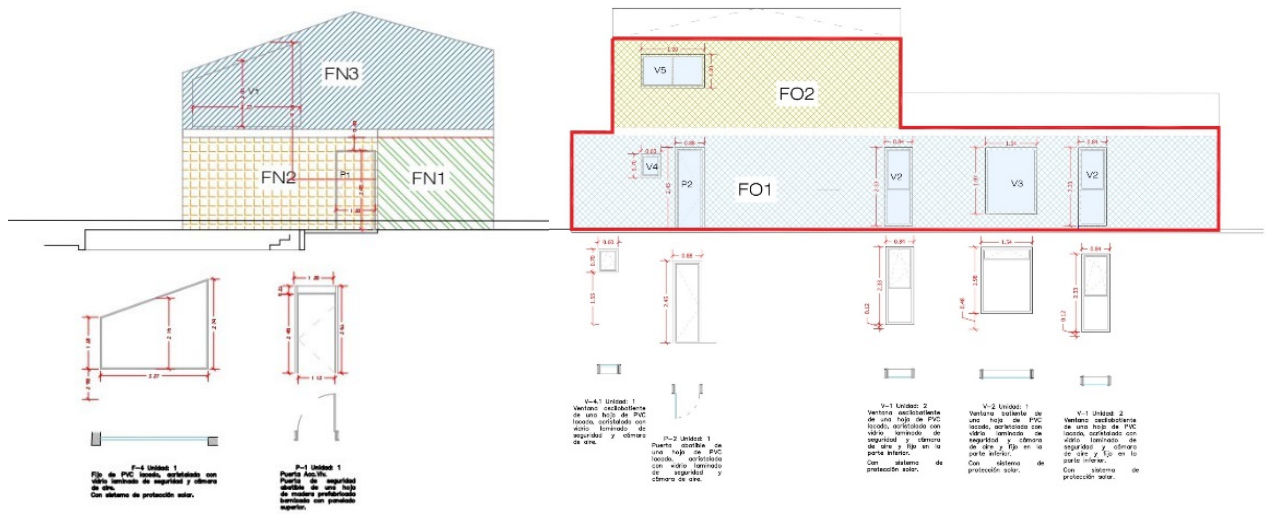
Imagen de elaboración propia para la identificación de fachadas.
